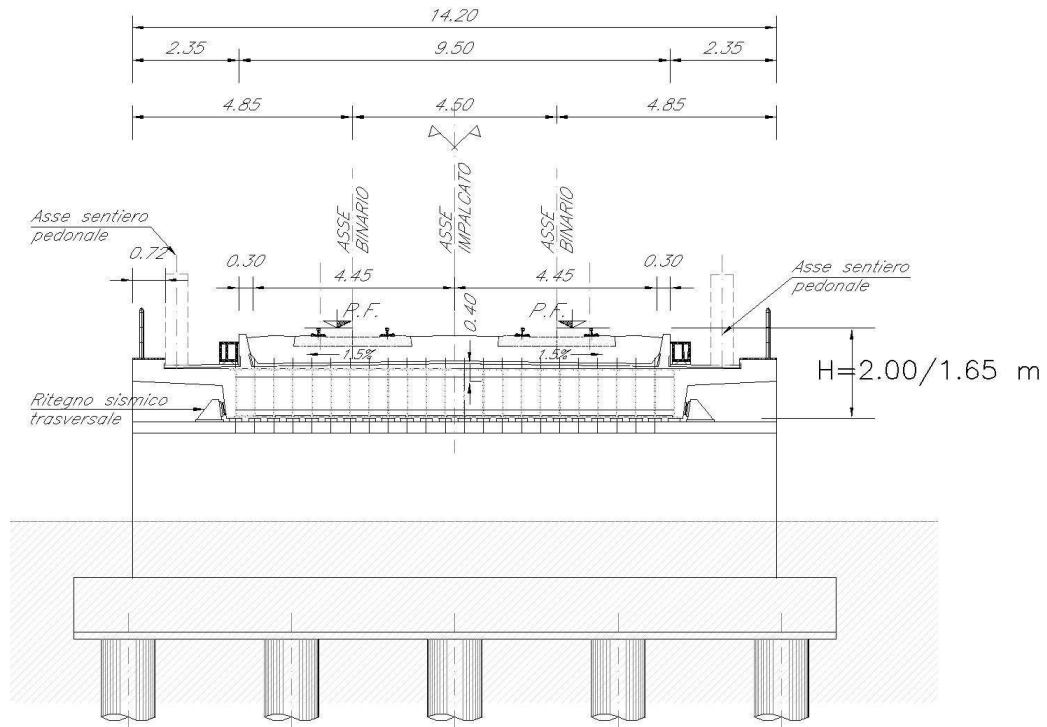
Sezione trasversale in asse appoggi della spalla tipo.
